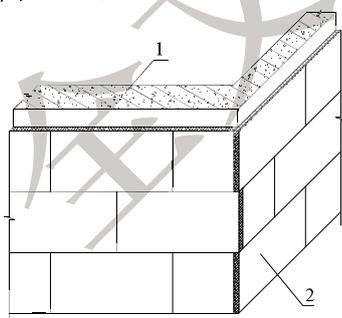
墙角保温板排板示意（尺寸单位：mm）
